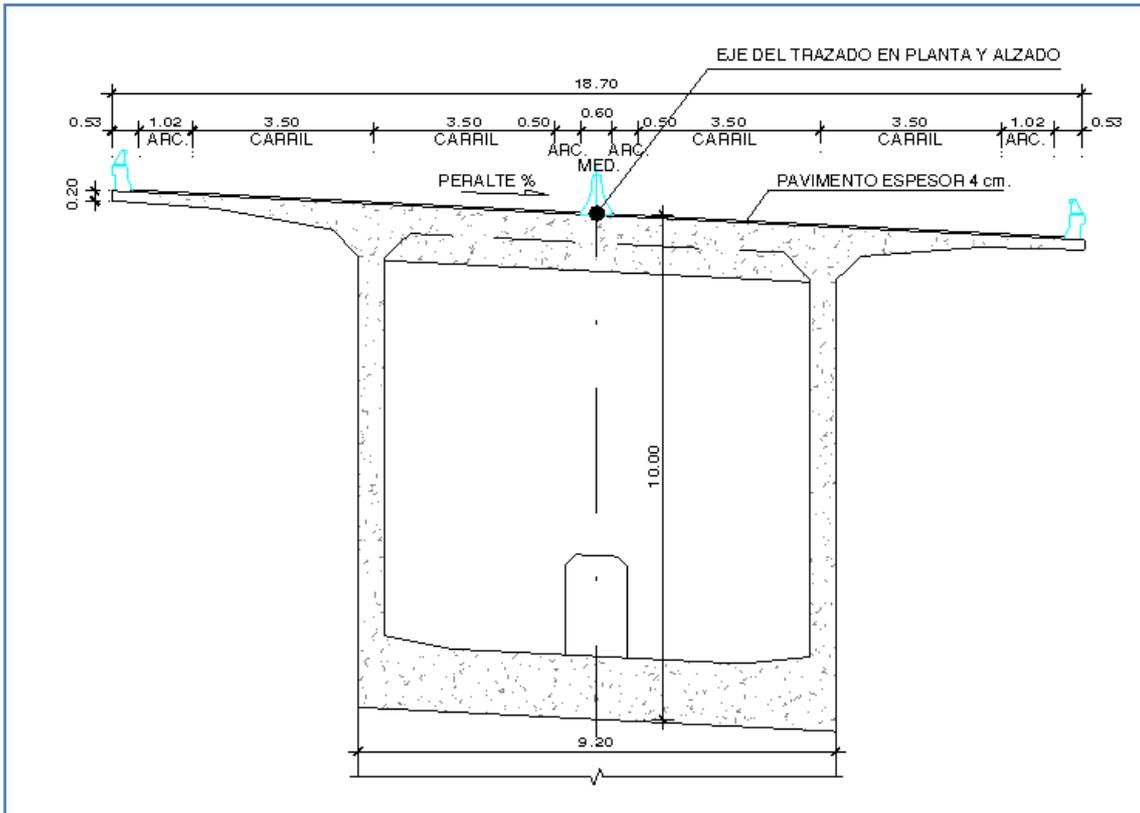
CORTE TRANSVERSAL SOBRE PILAS 2 A 5.
